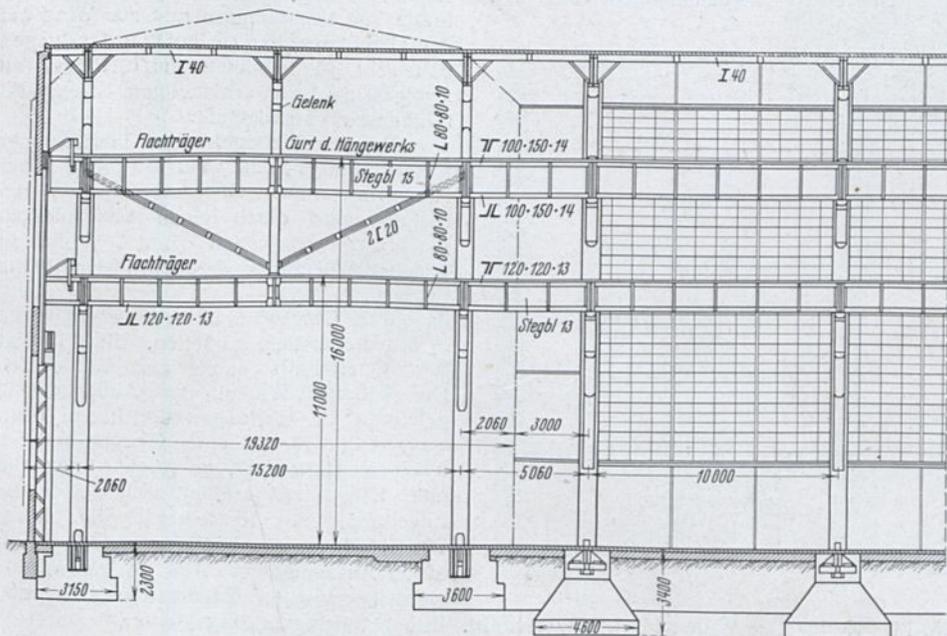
Montagehalle Schöneeweide. Längsschnitt.
